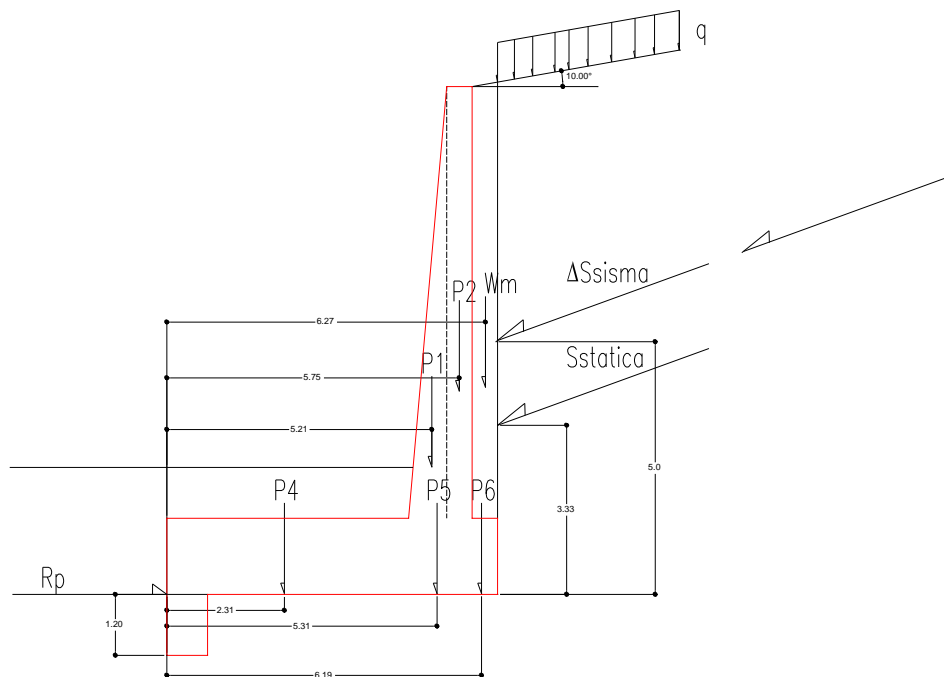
Carpenteria tipo A : Schema delle azioni agenti sul muro
